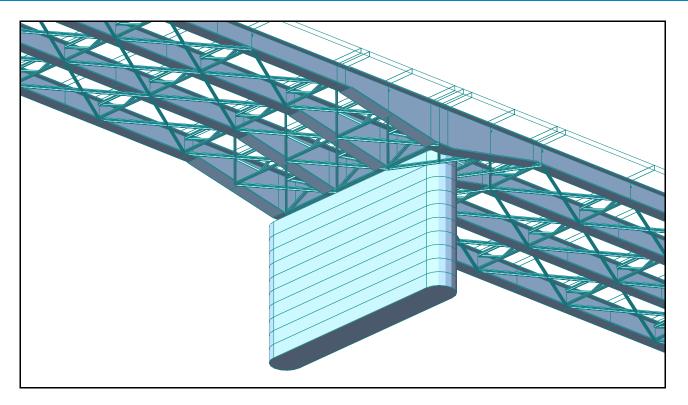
SCHEMA DI CALCOLO - PARTICOLARE SU PILA
